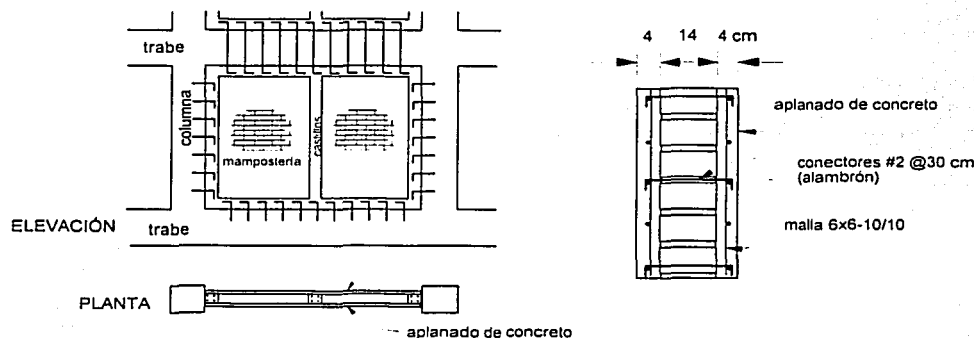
Detalles del refuerzo del proyecto no. 1
